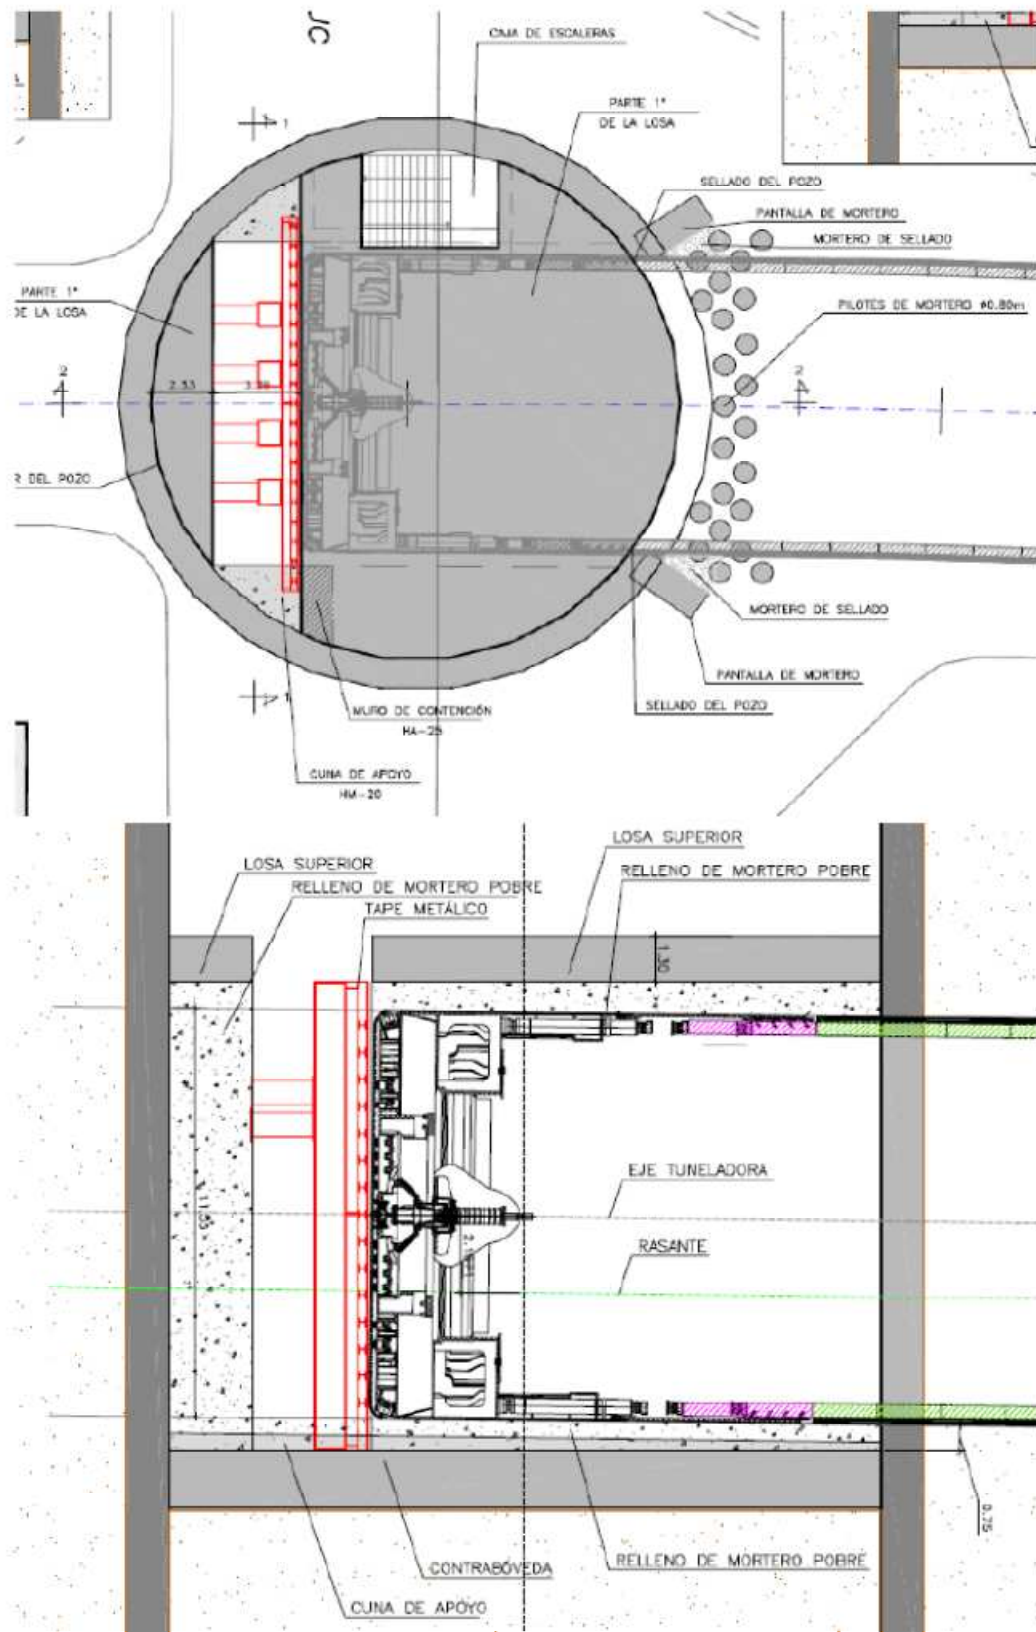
Croquis de planta y alzado alternativa coralitos interiores.
